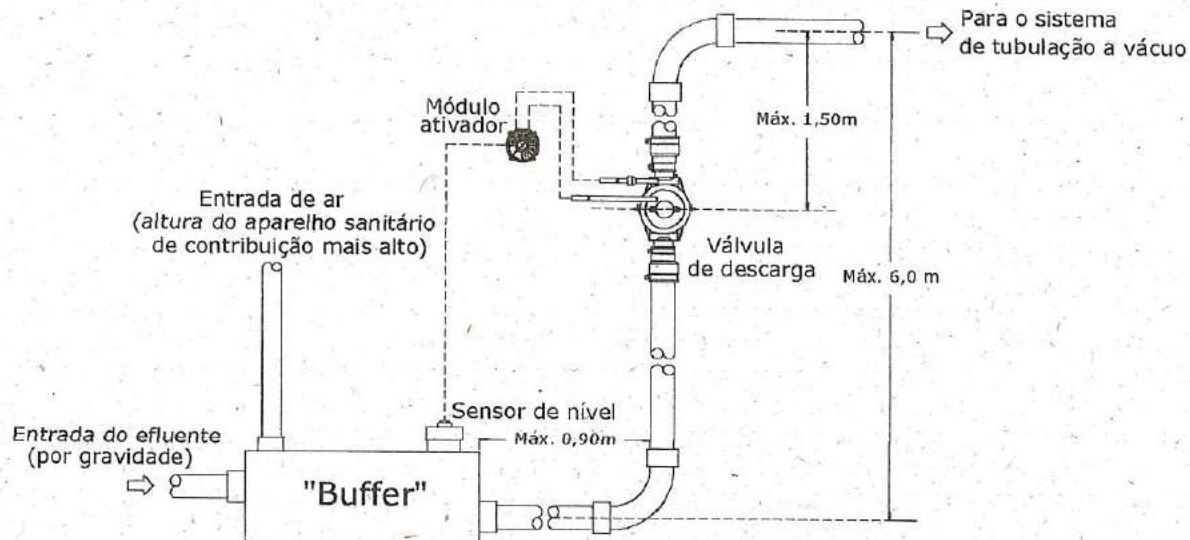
Arranjo com elevação - válvula de descarga à 3/4 da elevação.
